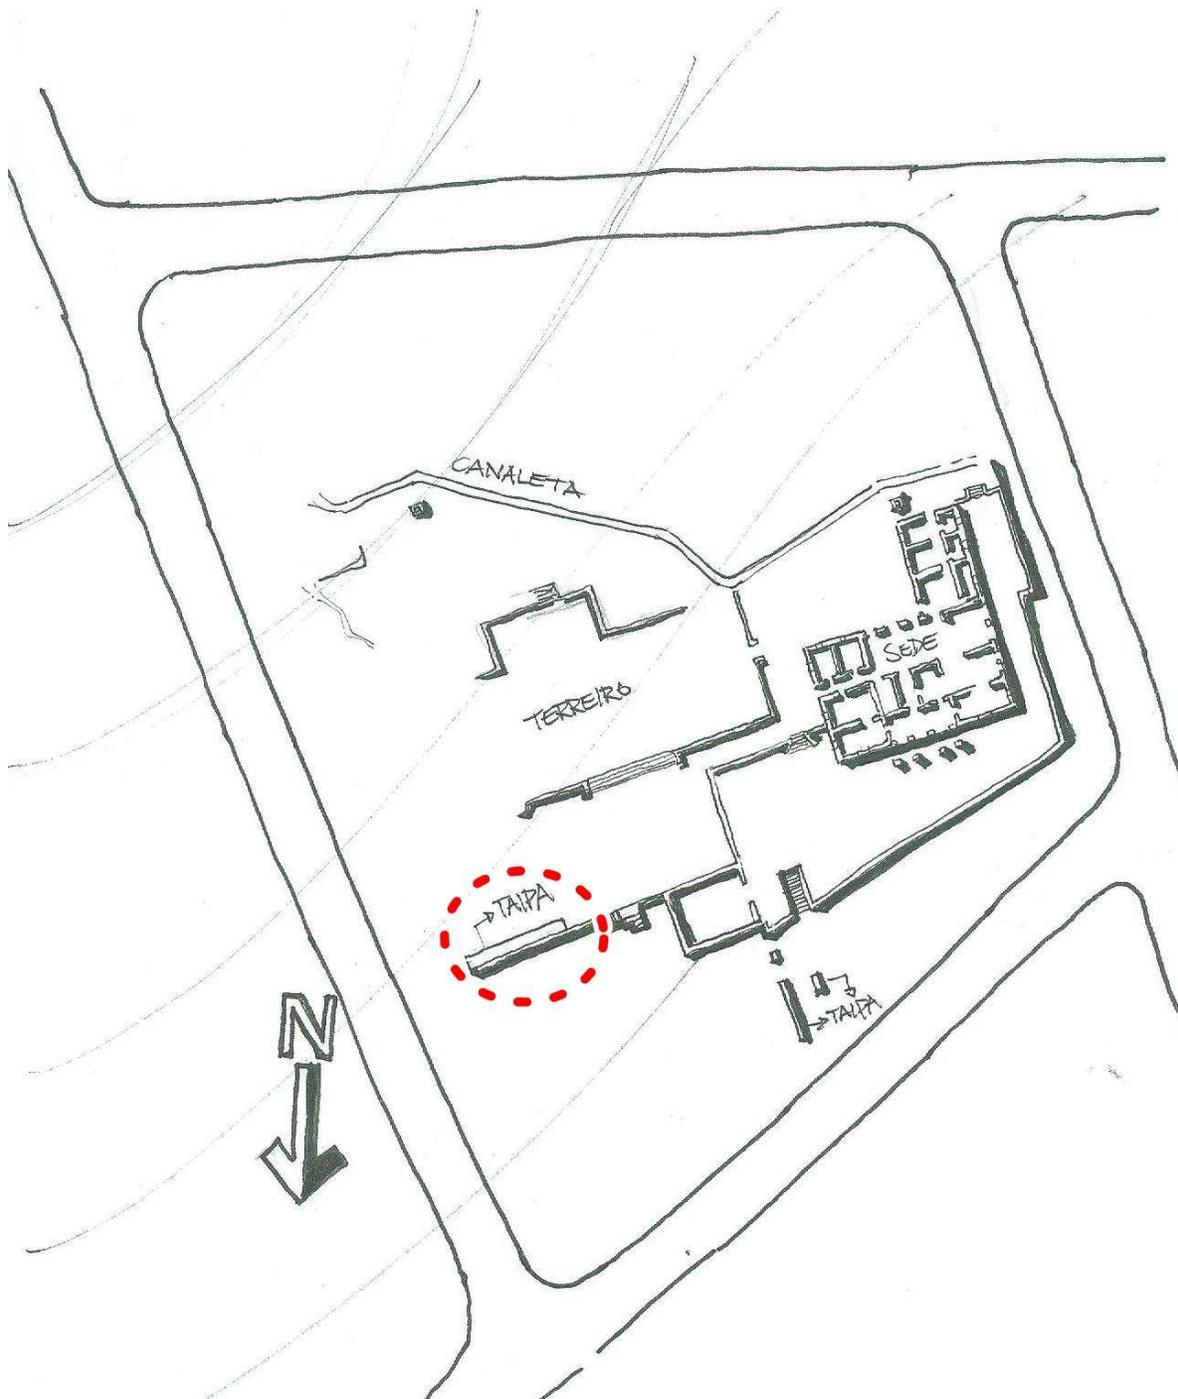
Detalhe da tulha da Fazenda Jambeiro na Implantação.
